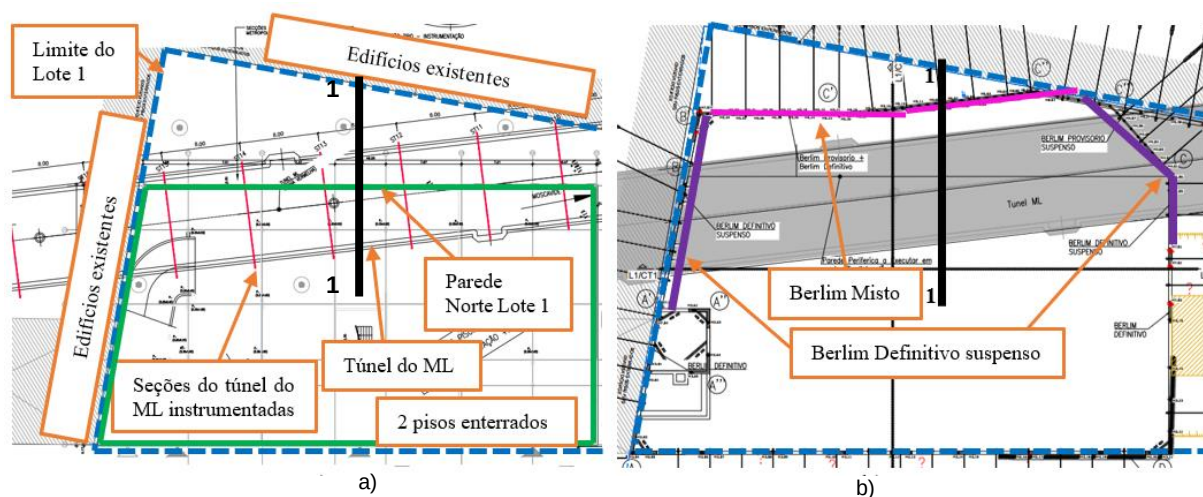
a) Planta de envoltório de condicionamentos do Lote 1. b) Soluções de escavação e contenção periférica – Lote 1
